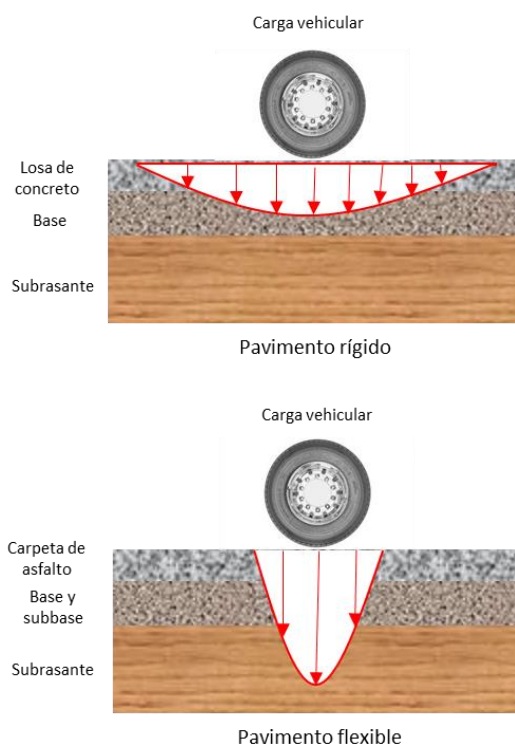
Distribución de esfuerzos en un pavimento rígido y en uno flexible. Fuente: ICCG.
